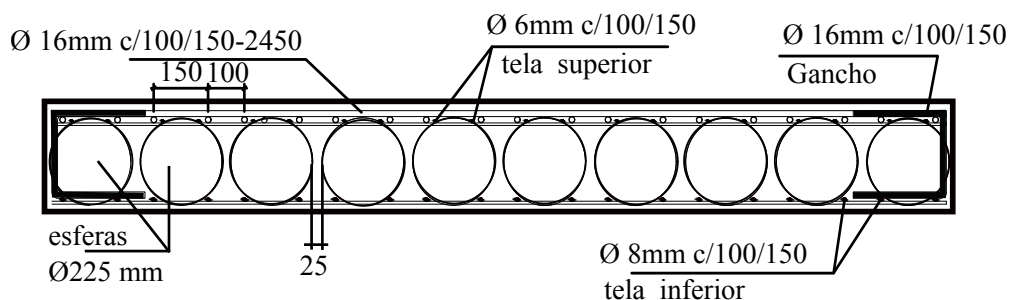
Detalhe da armadura de flexão, seção transversal, medidas em mm
